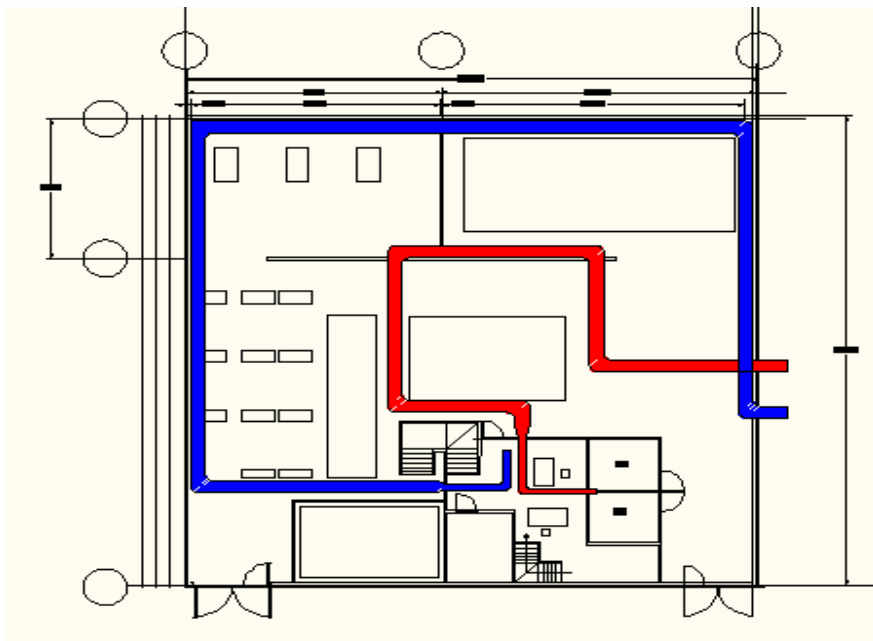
; Ductos de distribución del aire acondicionado en la planta baja.
